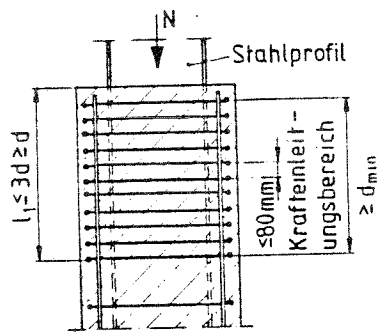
Verankerungslänge im Krafteinleitungsbereich
